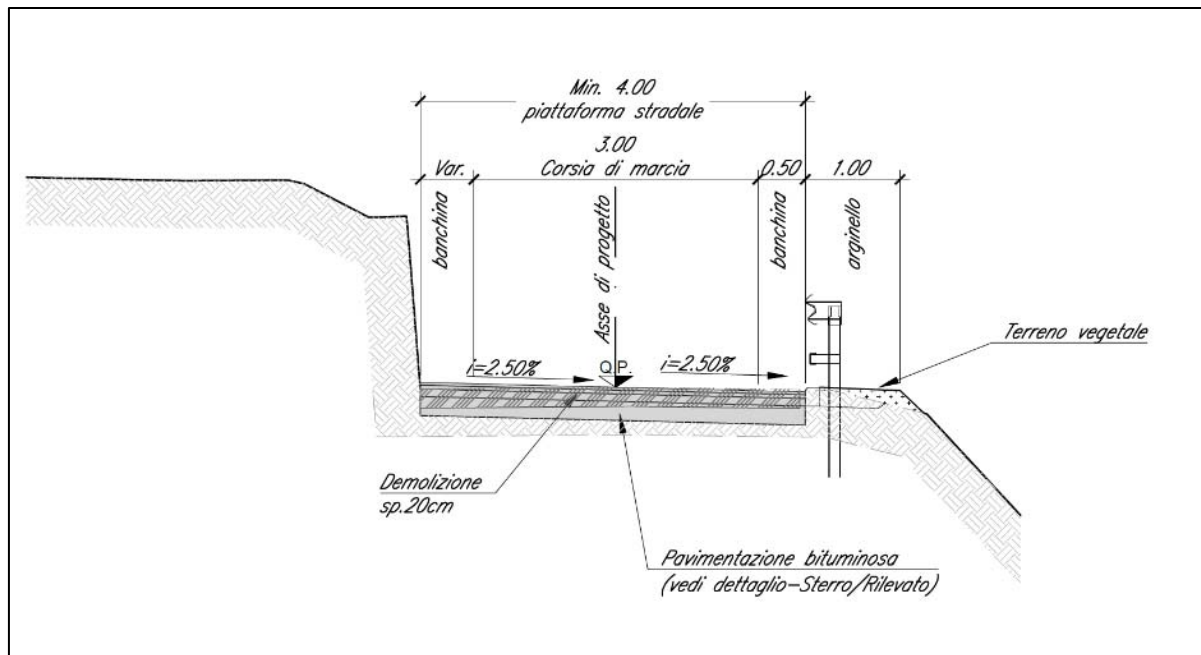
Sezione tipo NV14-Allargamento 1 (Leggero sterro)
